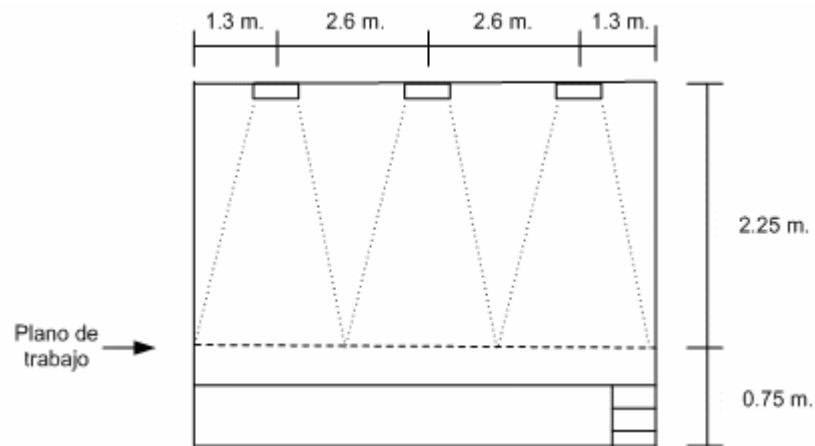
Distribución de luminarias salón 203 (Planta)
